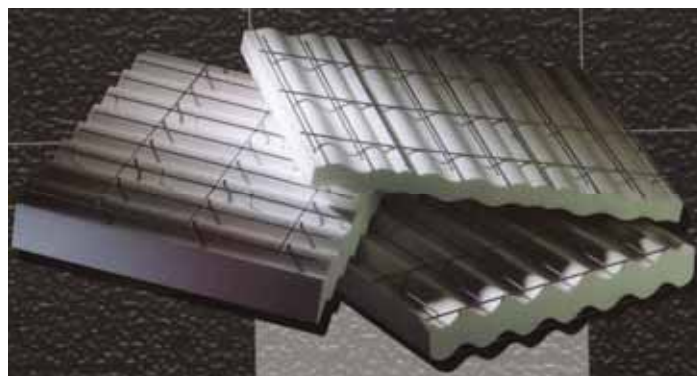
Painéis do sistema construtivo com núcleo de poliestireno e tela de aço eletro soldada.
